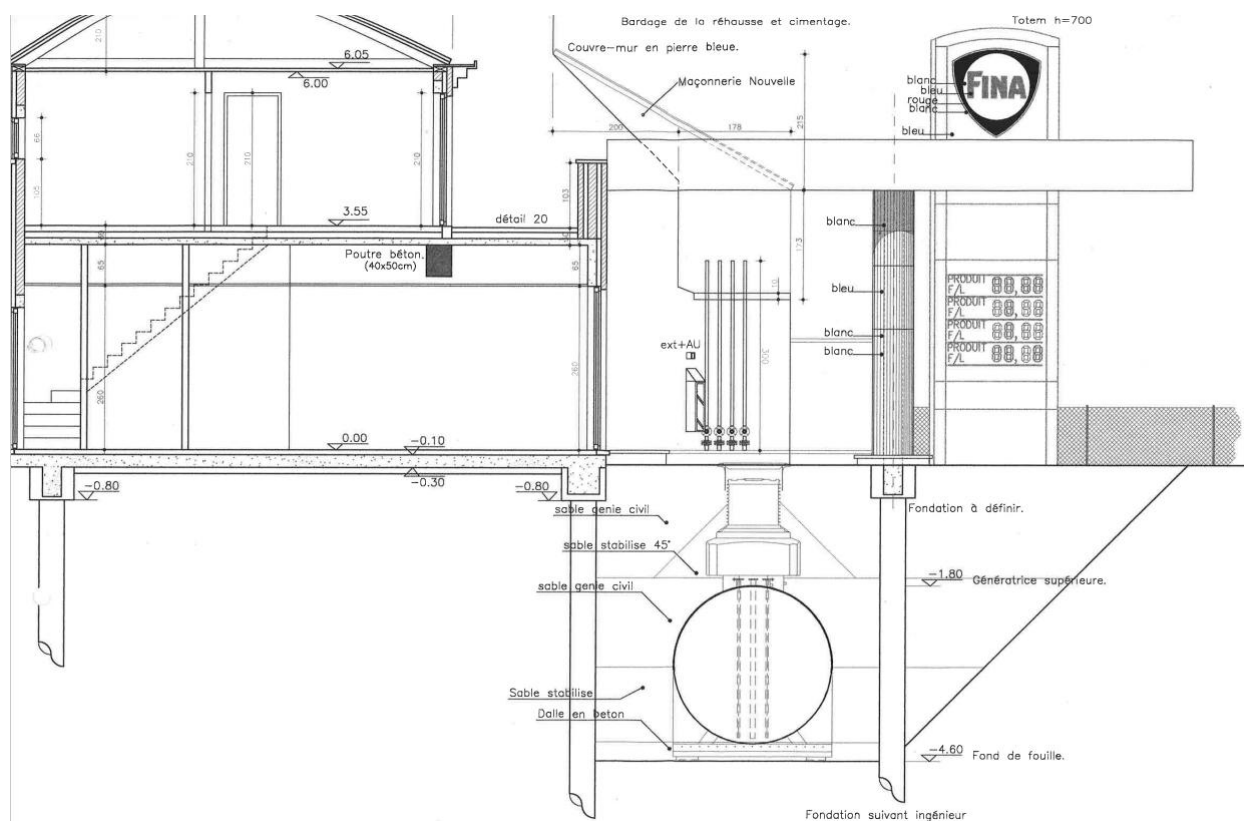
Coupe du projet de rénovation du bâtiment de 1998
